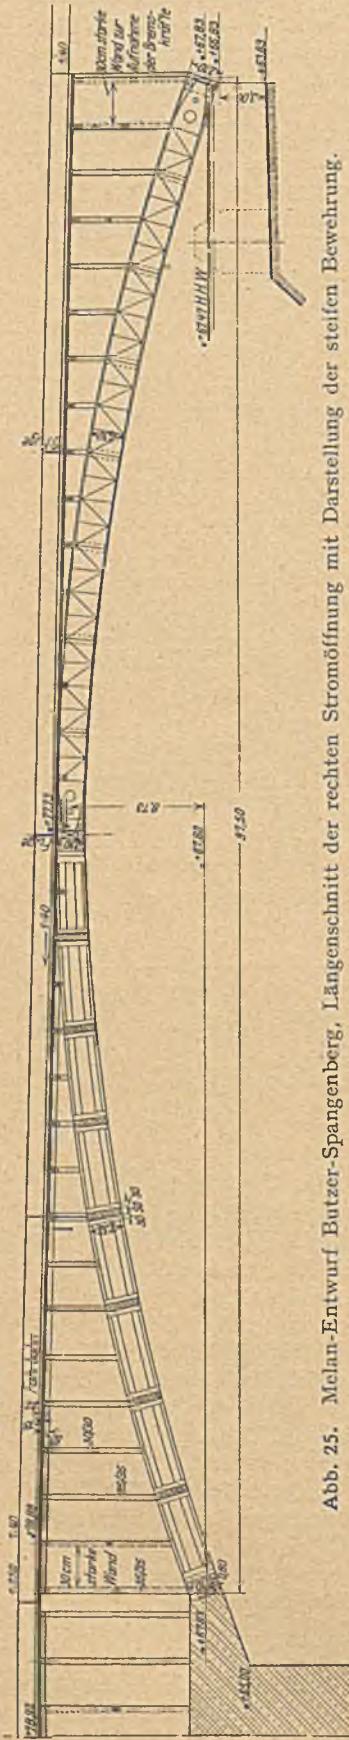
Melan-Entwurf Butzer-Spangenberg, Längenschnitt der rechten Stromöffnung mit Darstellung der steifen Bewehrung.
